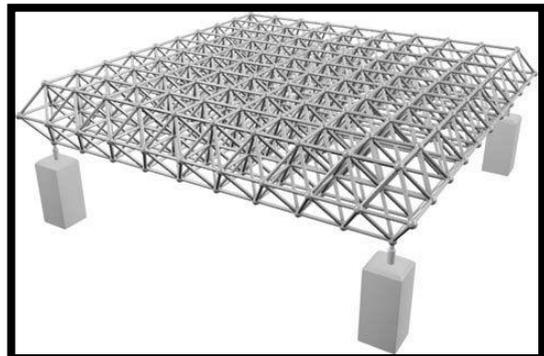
structure tridimensionnelle, socle béton armé, poutre en treillis
